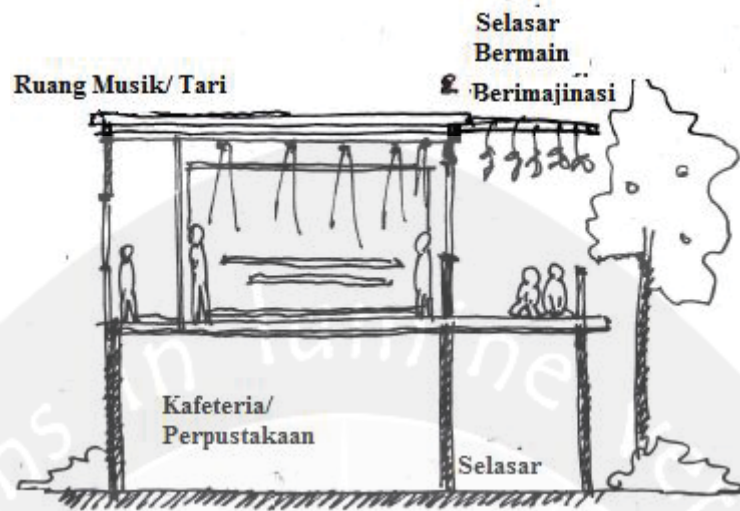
Konsep Desain Ruang Serba Guna Lantai 1
